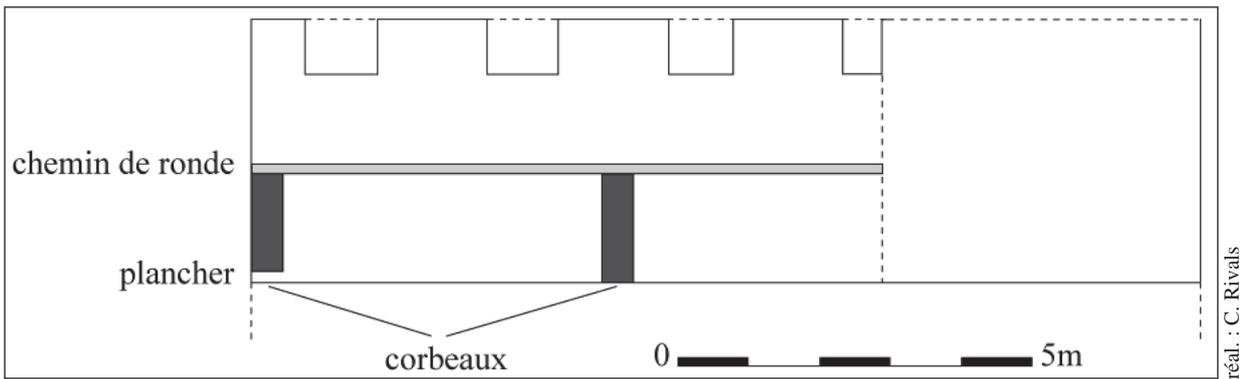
croquis à l'échelle de l'élévation du mur est au troisième étage
